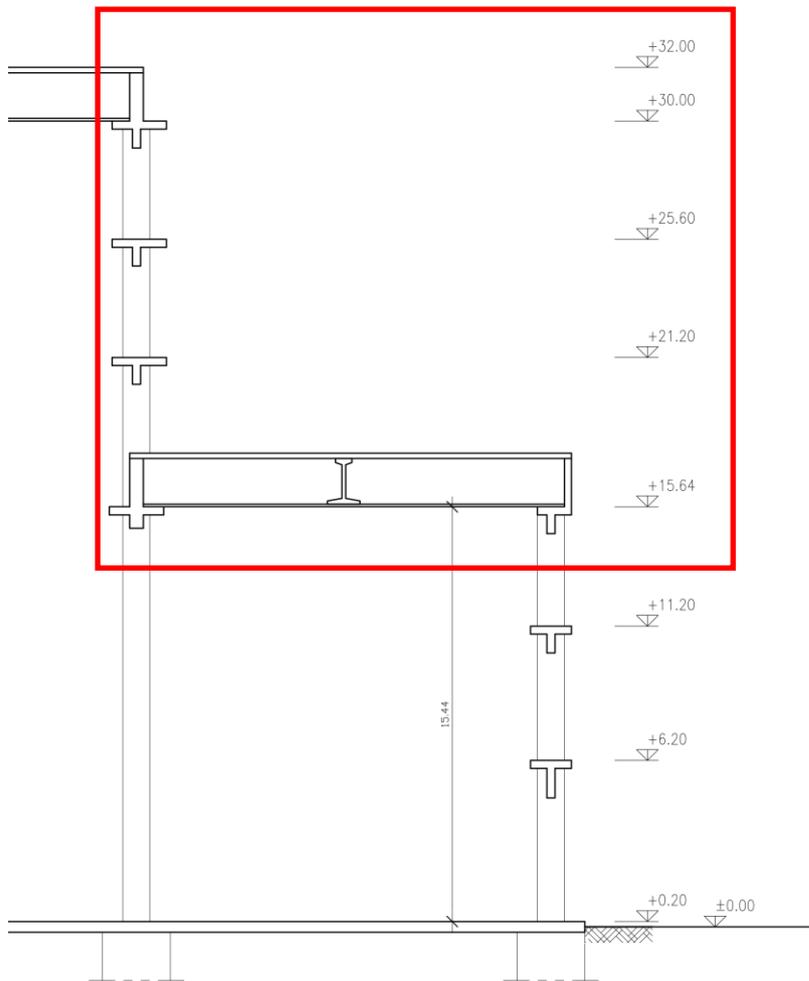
Sezione del fabbricato esistente interessato dall'intervento di sopraelevazione
